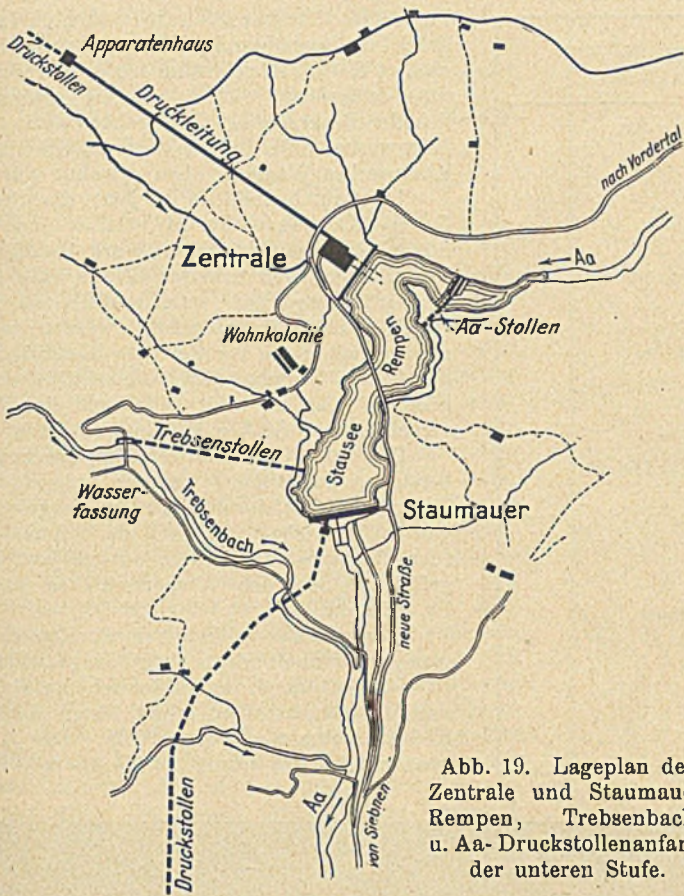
Lageplan der Zentrale und Staumauer Rempen, Trebsenbach- u. Aa-Druckstollenanfang der unteren Stufe.
